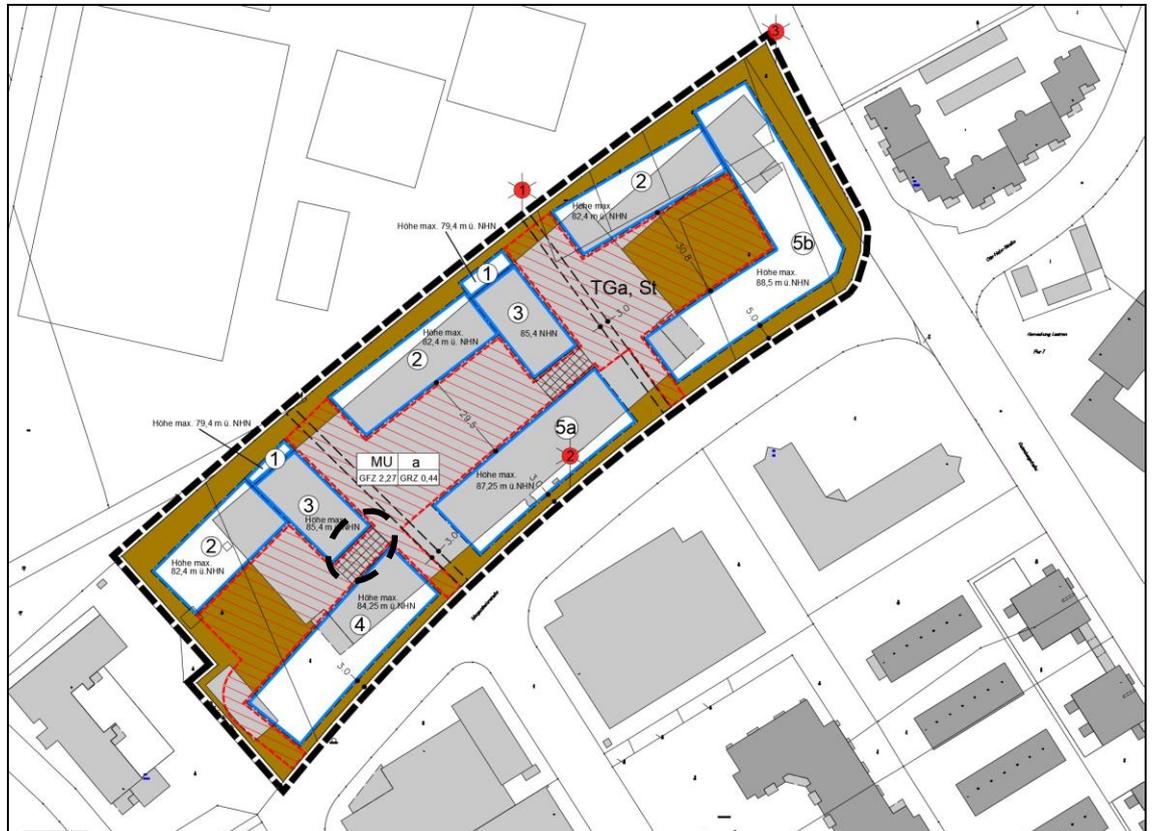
Ausschnitt aus dem VBB Nr. 13 „Mergenthalerstraße“ (gesondert gekennzeichnete Flächen sind schwarz gestrichelt umrandet)
